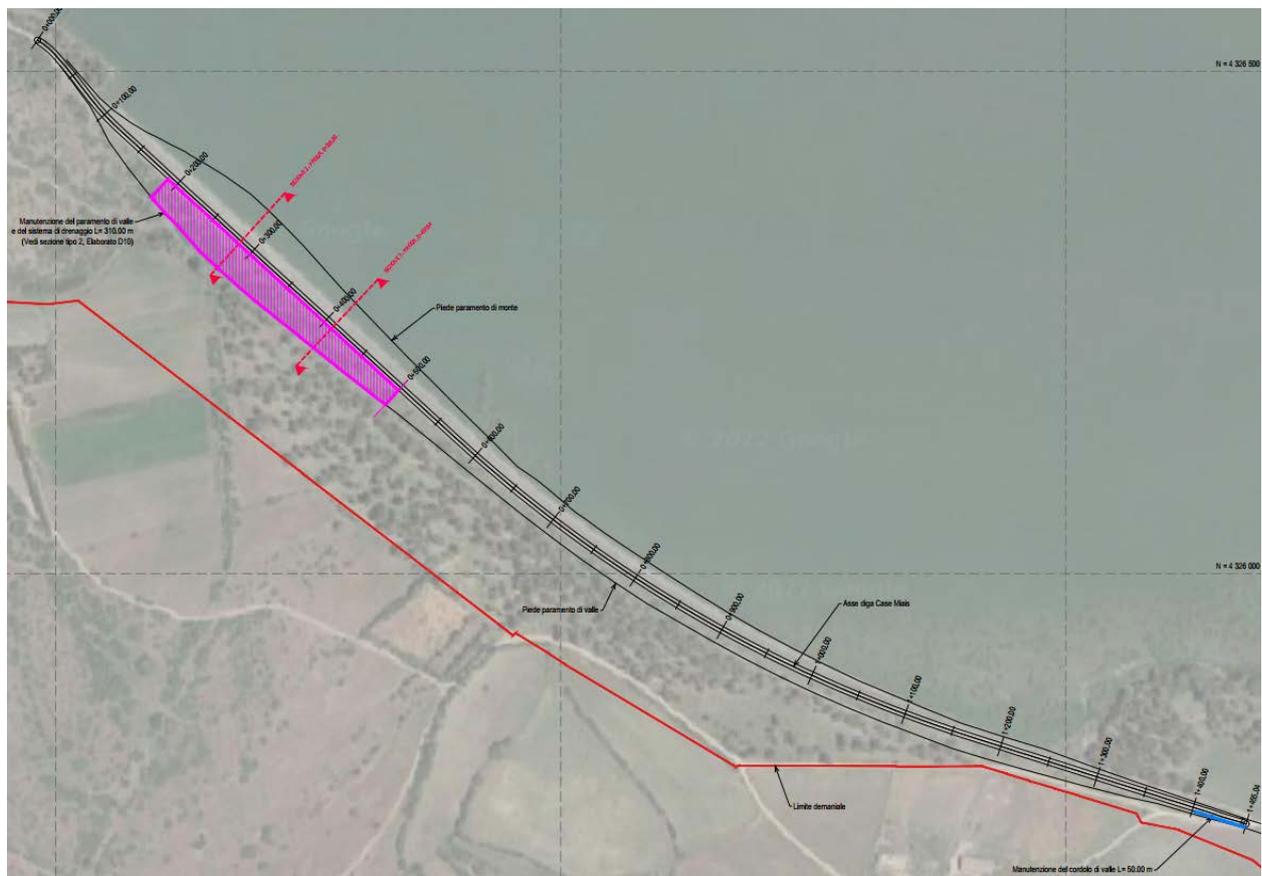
Planimetria con ubicazione dell'intervento su Case Miais
